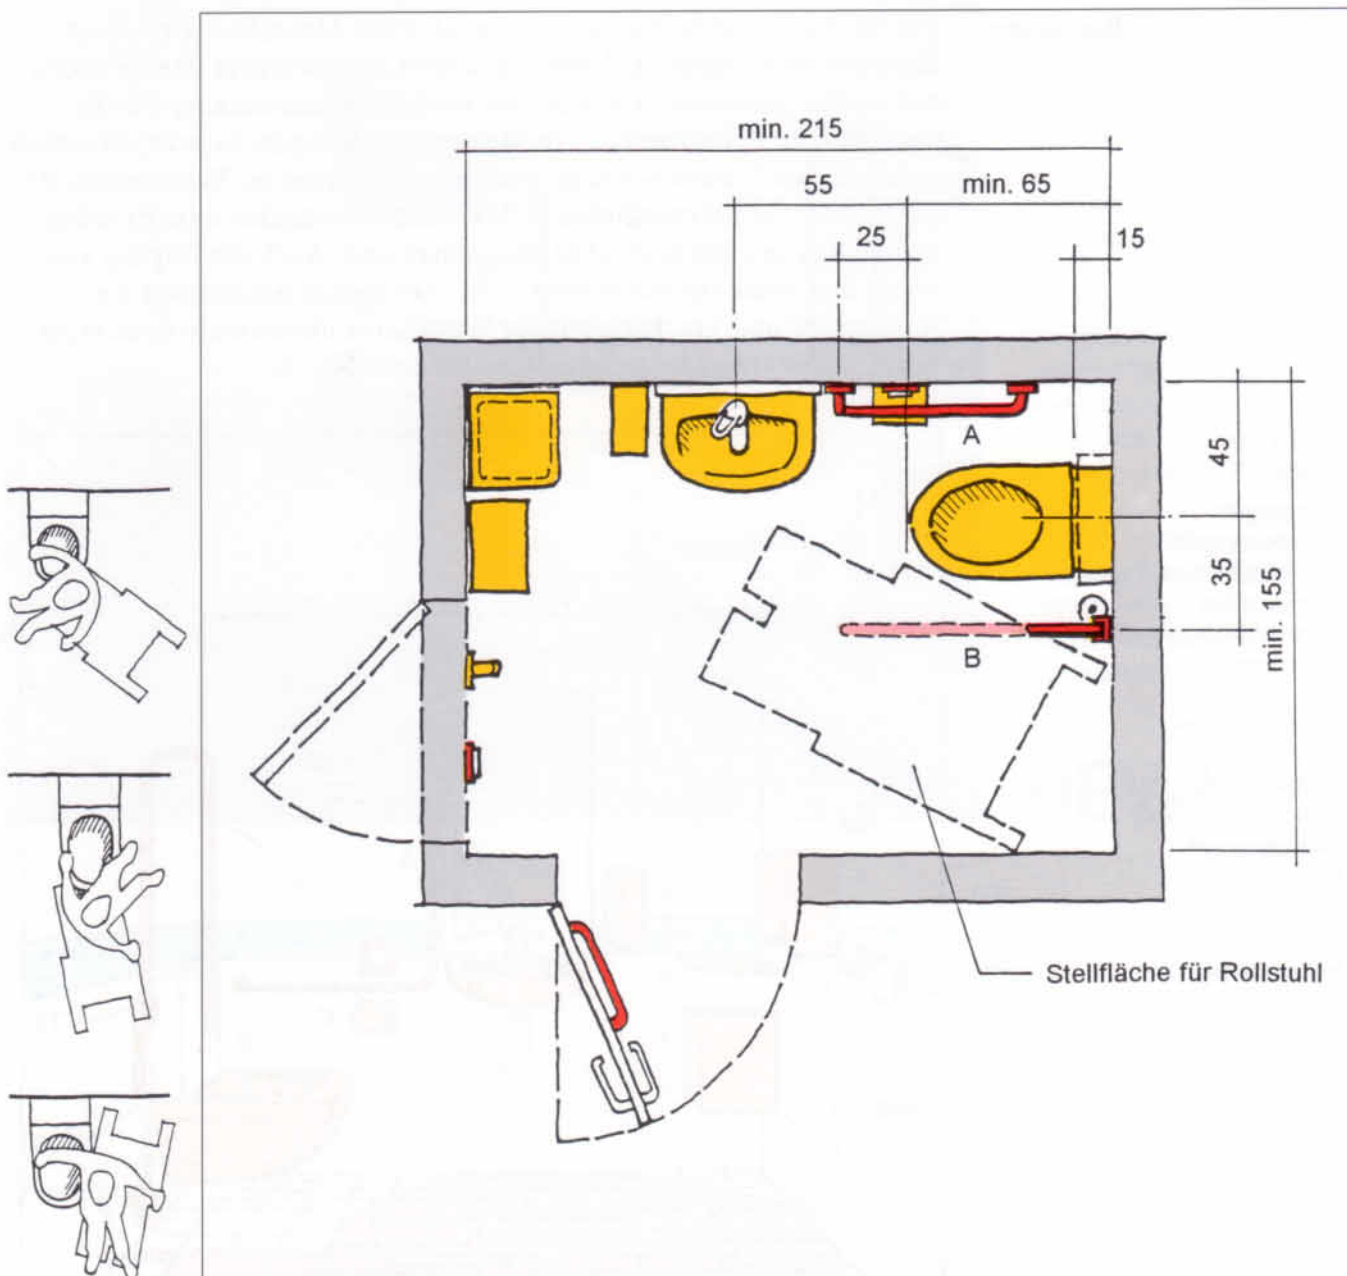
Grundriß zu Bild 1 (Mindestgröße nach ÖNORM B 1600)
